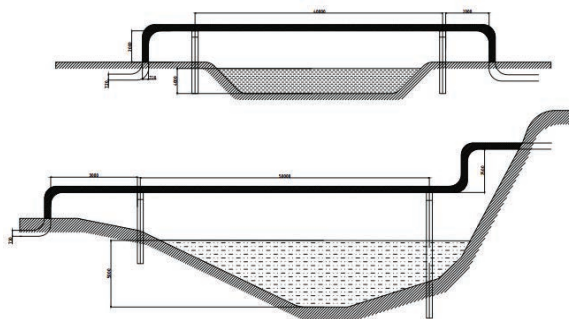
Схема перехода трубопровода с помощью балочного перехода.
